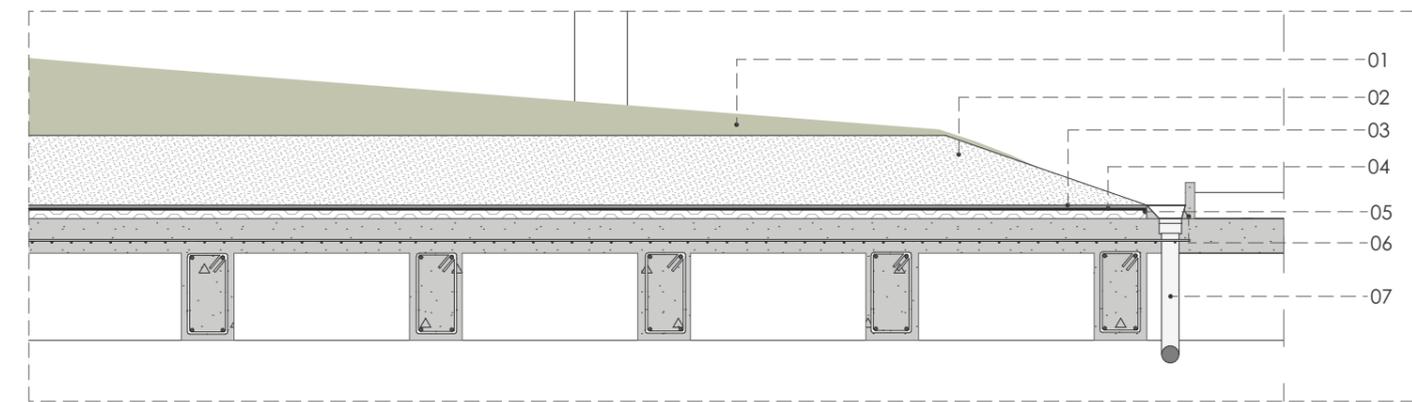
Detalle constructivo capa vegetal Fuente: Propia, 2022
